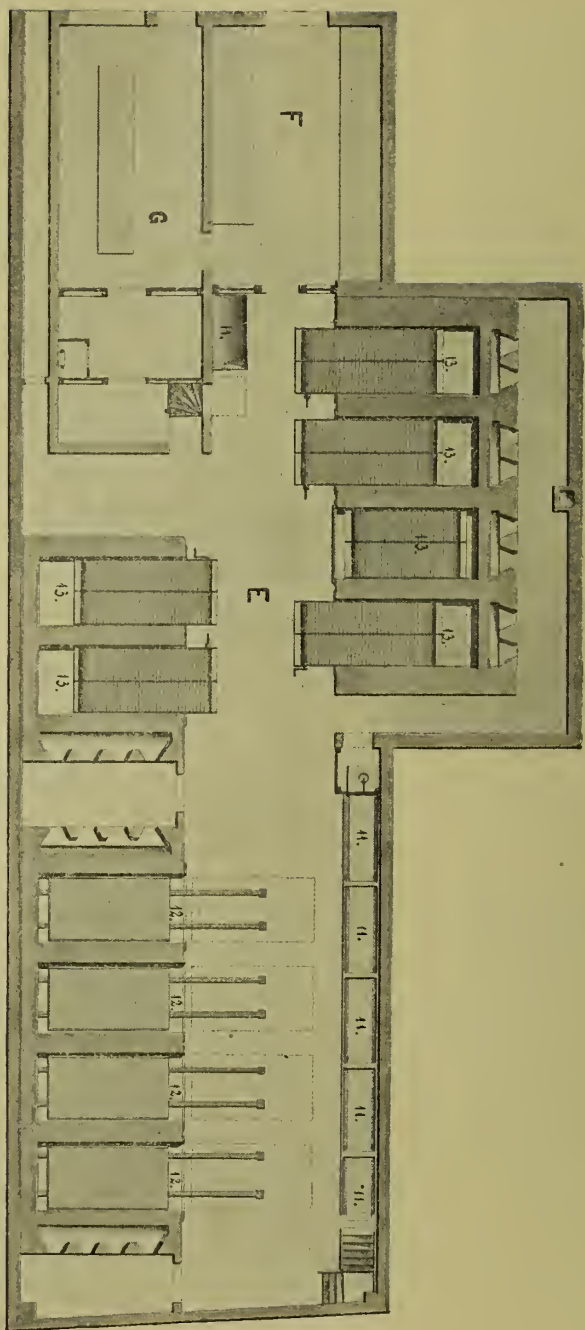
Grundriß des Ofenraumes einer englischen Strohfabrik, eingerichtet von Berner & Pfelebert.
